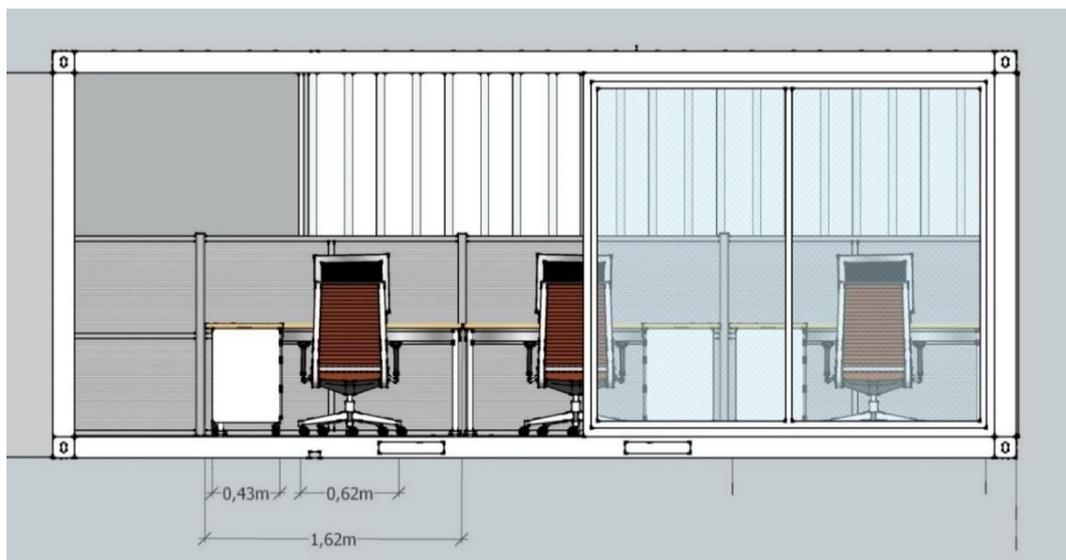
Ukuran Standar Elevation spacial bekerja privat
